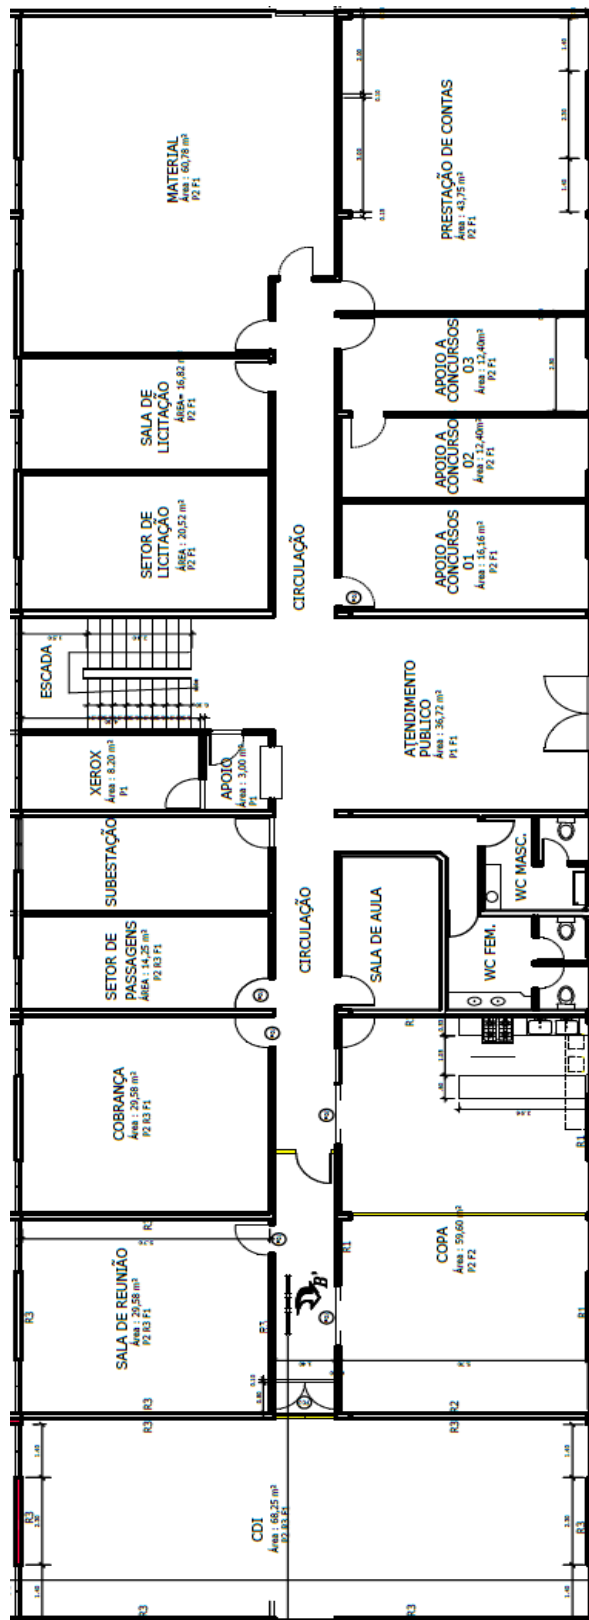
Planta baixa do piso térreo do prédio da FADESP.
